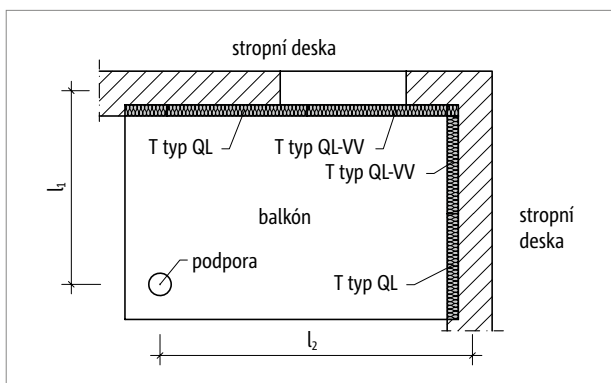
Schöck Isokorb® T typ QLN: Balkón se sloupovými podporami
